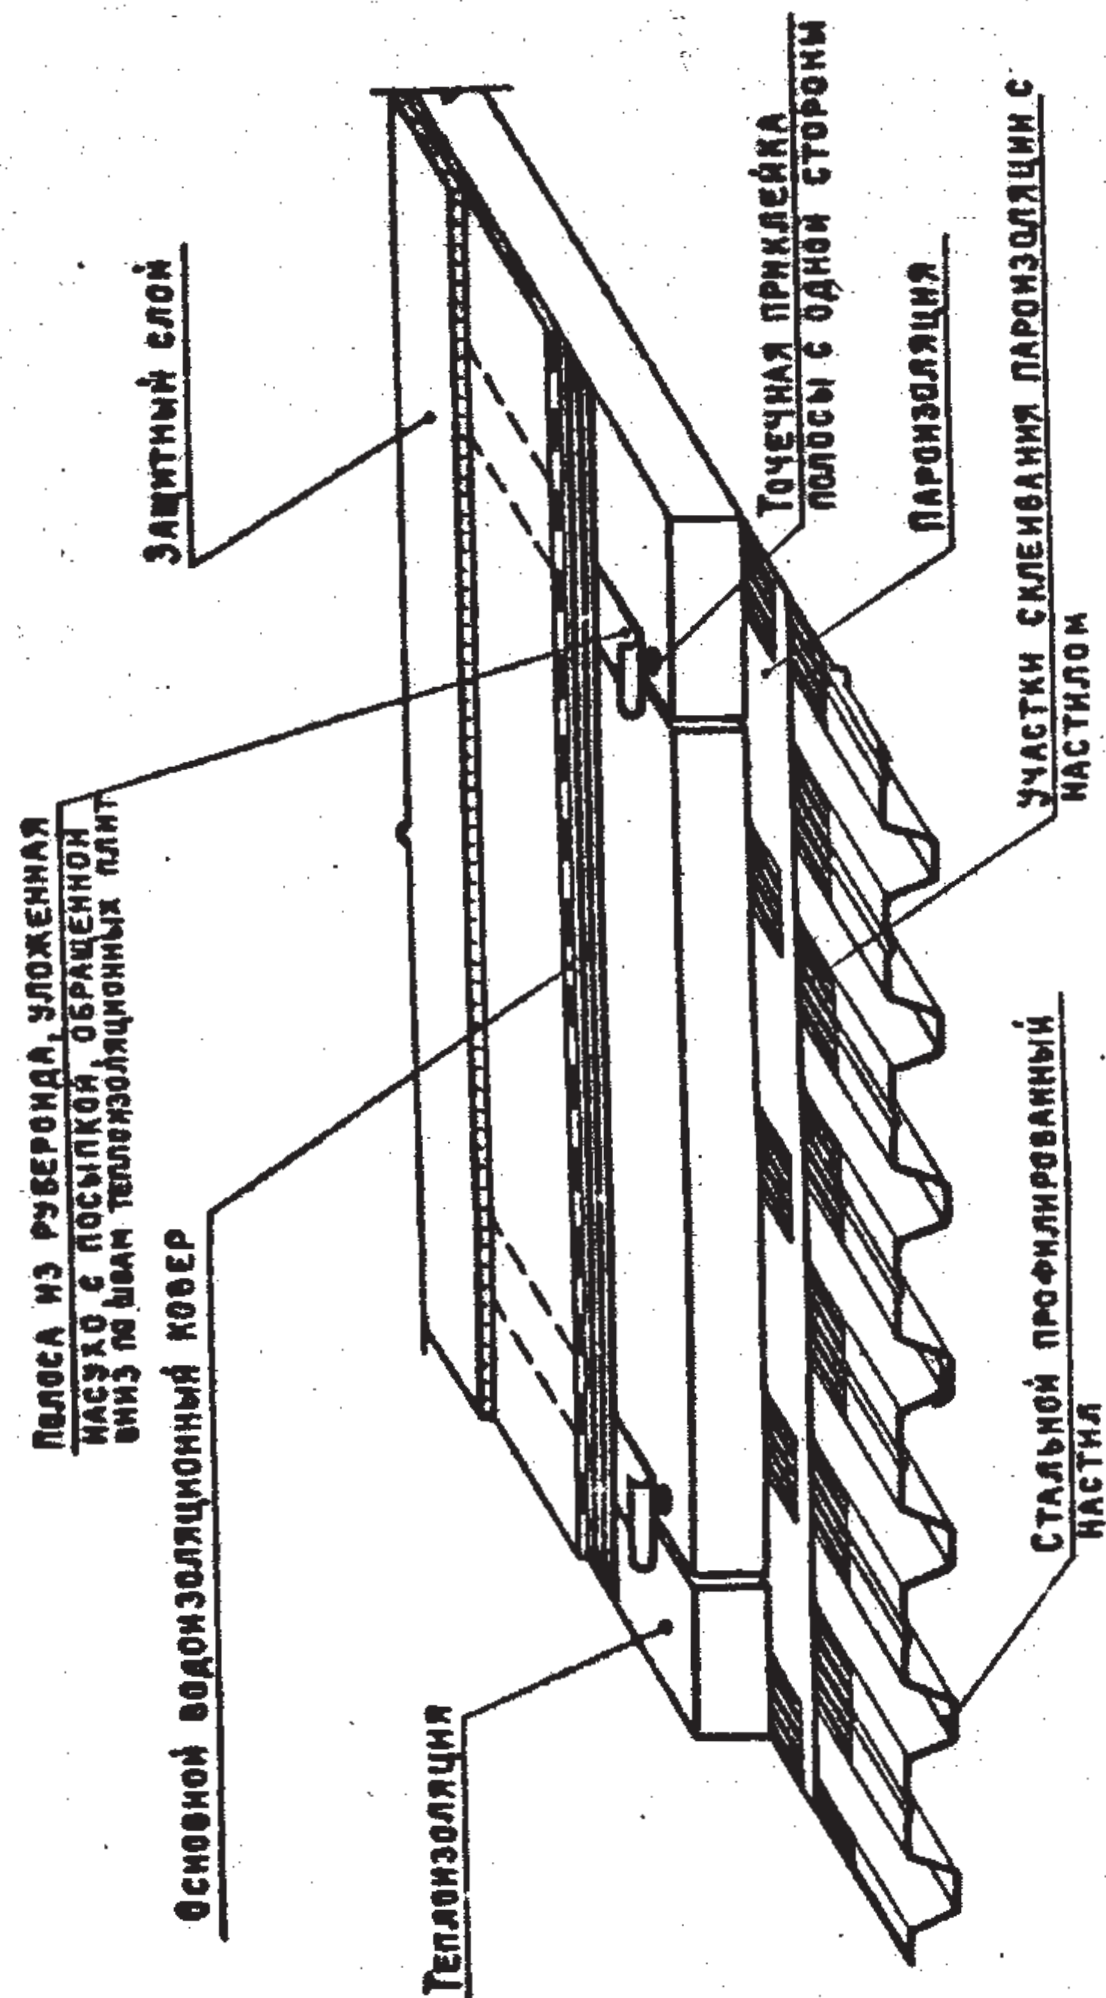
Для покрытий с теплоизоляцией — основанием под кровлю.
